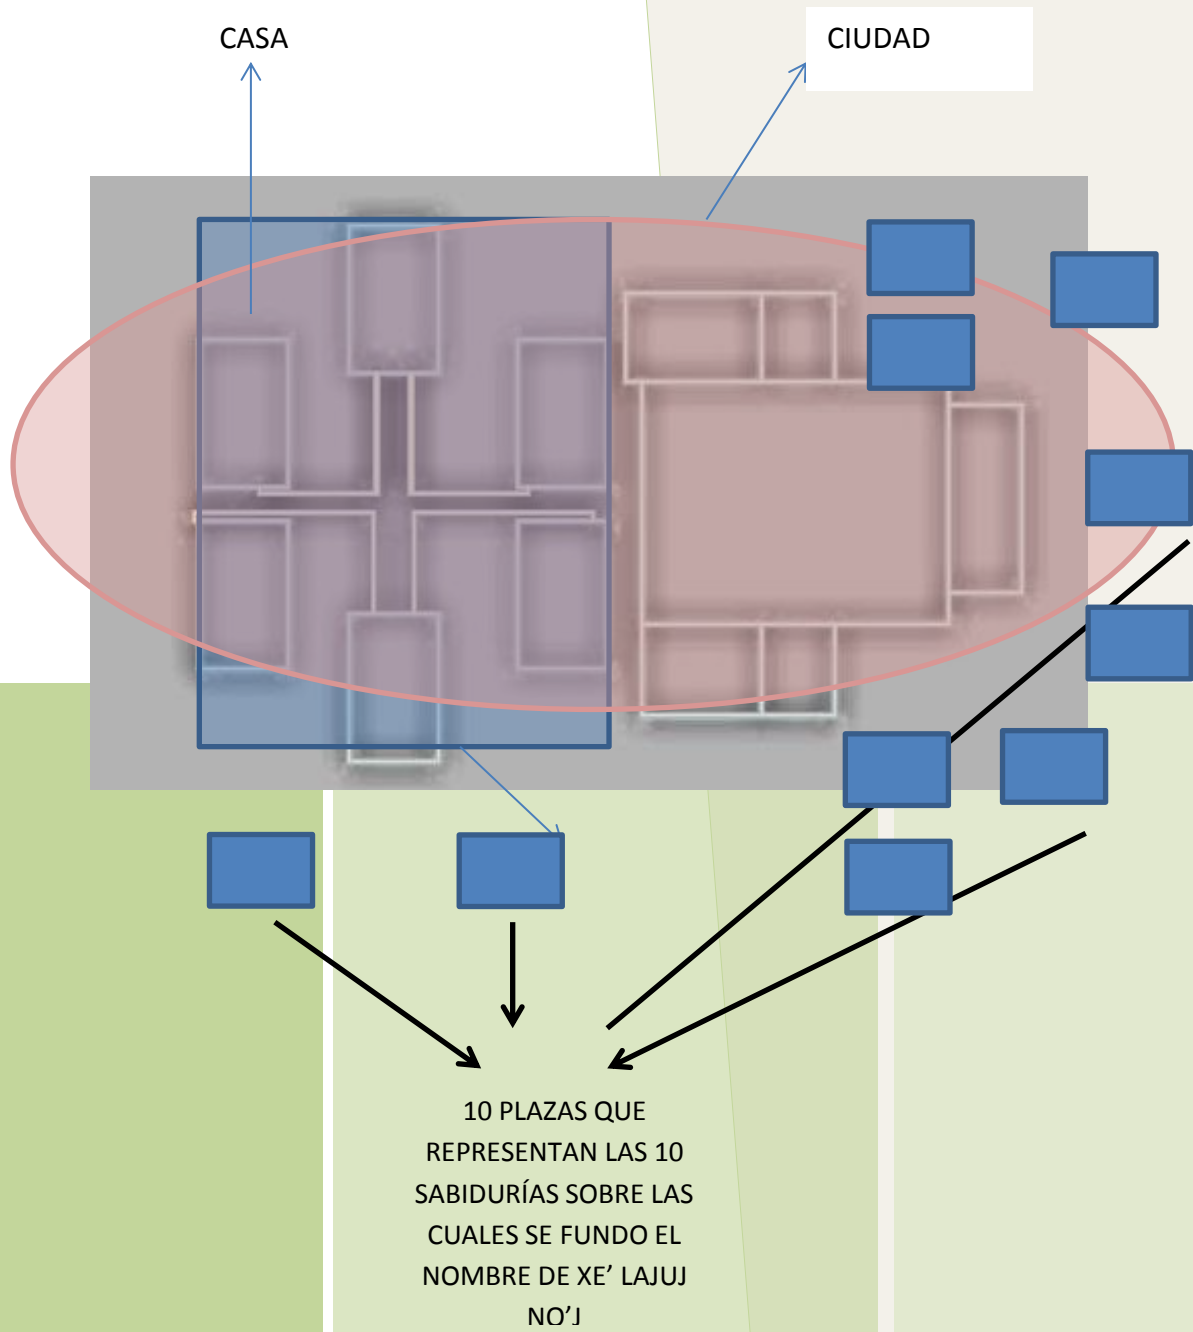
Planta de Idea generatriz de Proyecto. Fuente: Elaboración propia.
